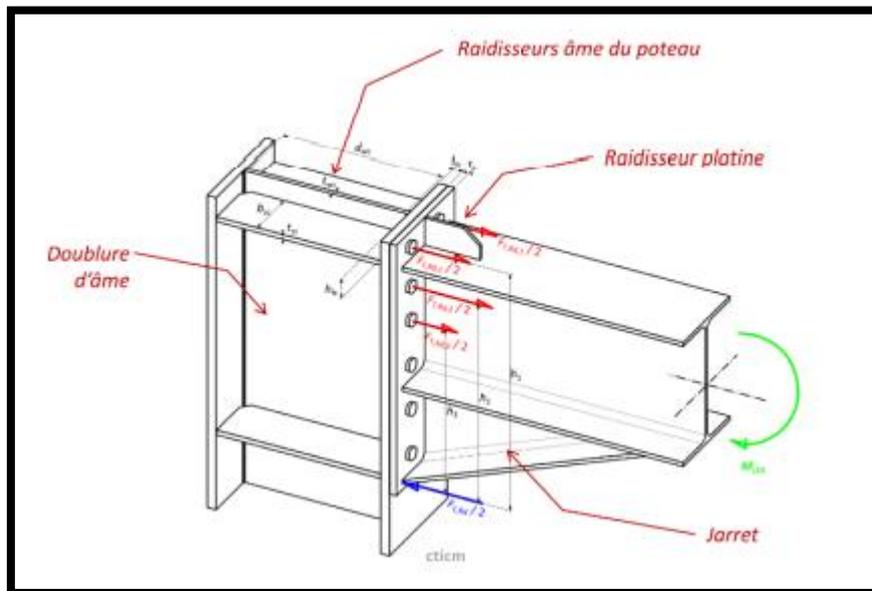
Assemblage poteaux-poutres (source: Centre Technique Industriel de la Construction Métallique)
